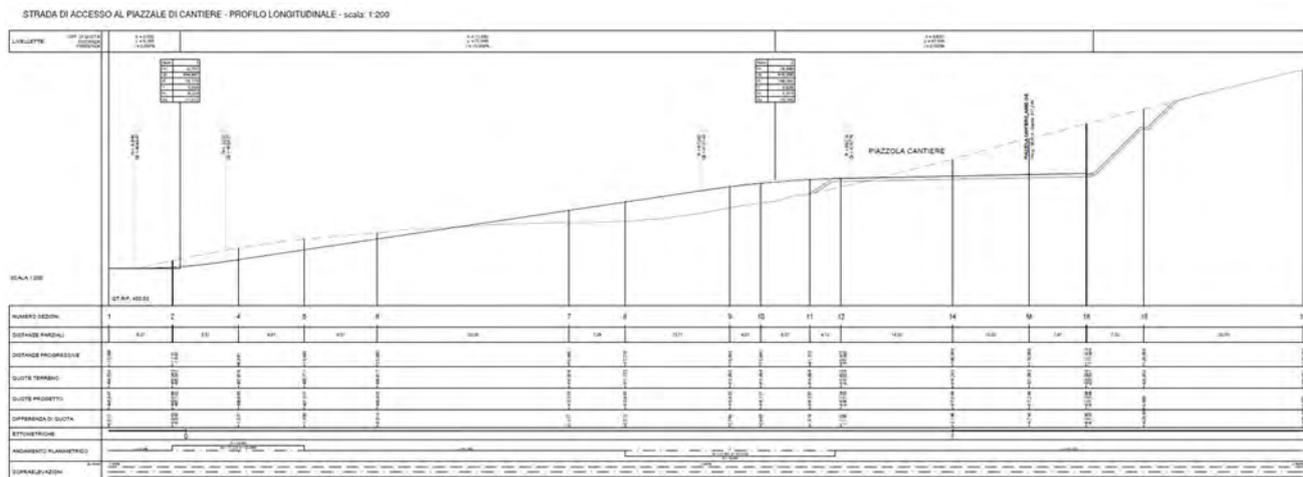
Strada di accesso al piazzale di cantiere - profilo longitudinale
